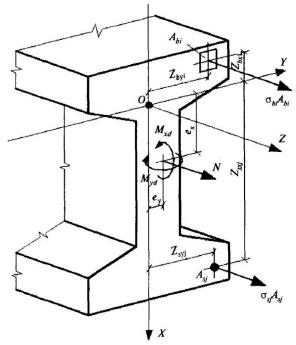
Расчетная схема нормального сечения элемента
